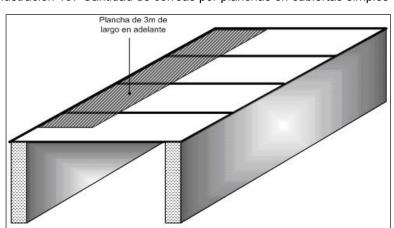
Cantidad de correas por planchas en cubiertas simples
